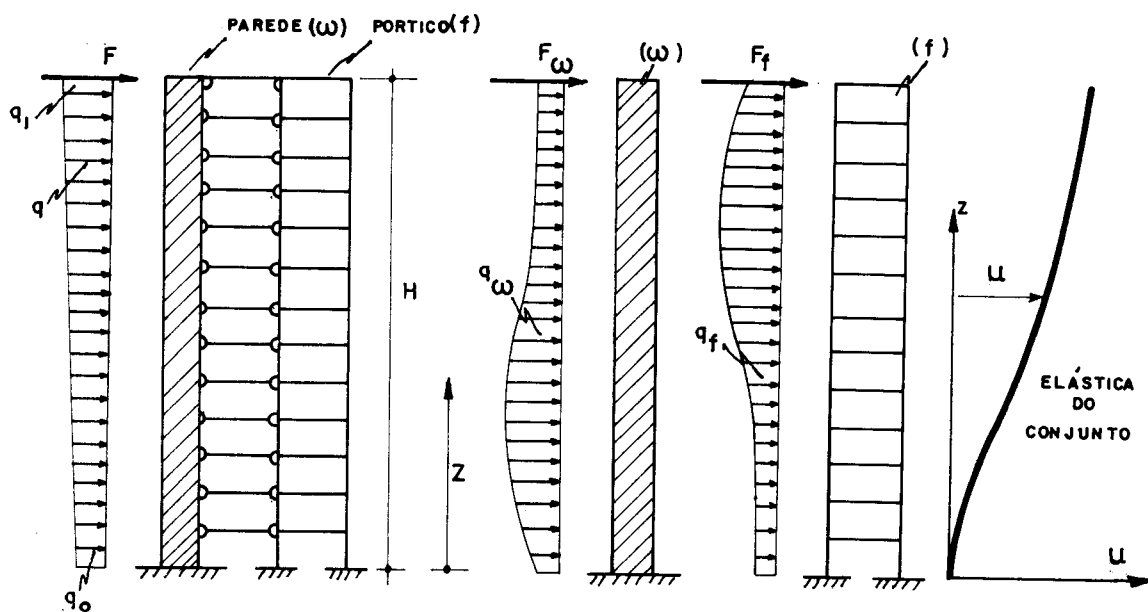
PÓRTICO E PAREDE EM SÉRIE
